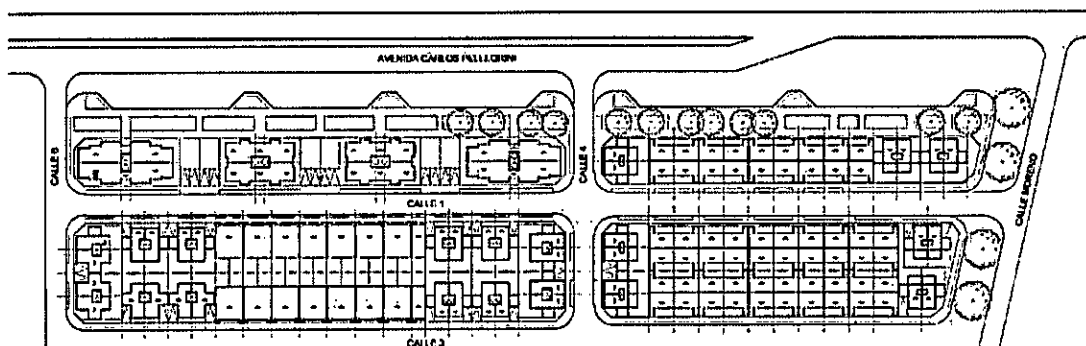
Figura VI. Planta general de las 174 vivienda entregadas en la etapa I | Elaboración propia
